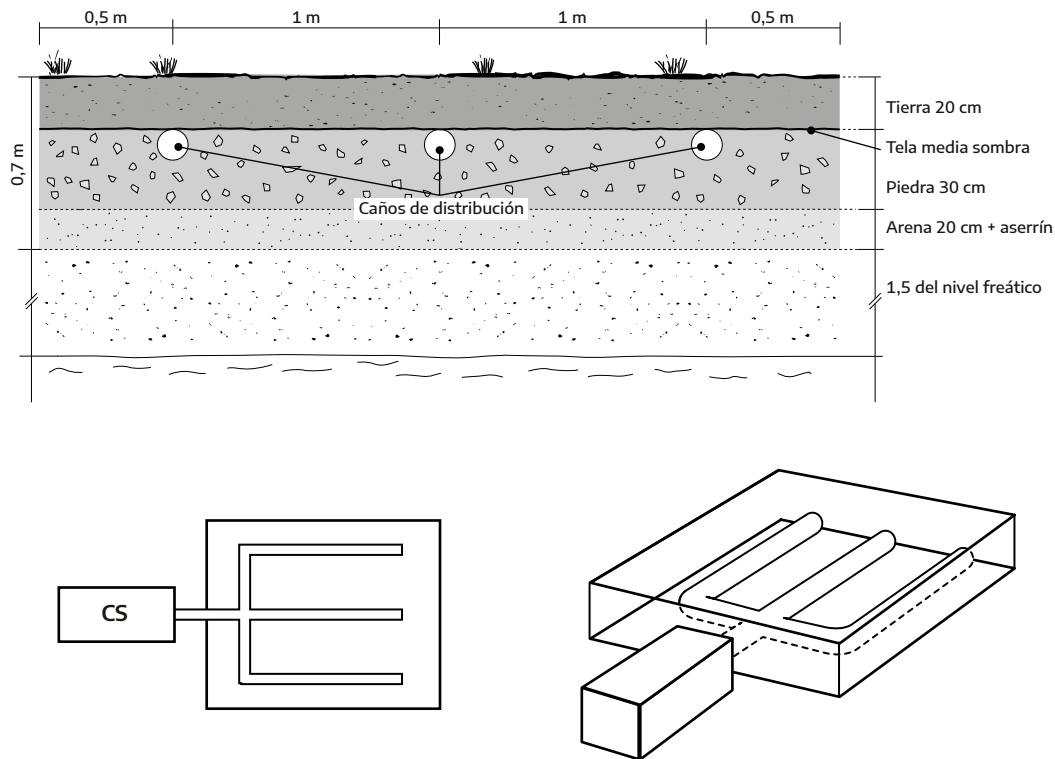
Lecho de infiltración. Corte, planta y perspectiva.
